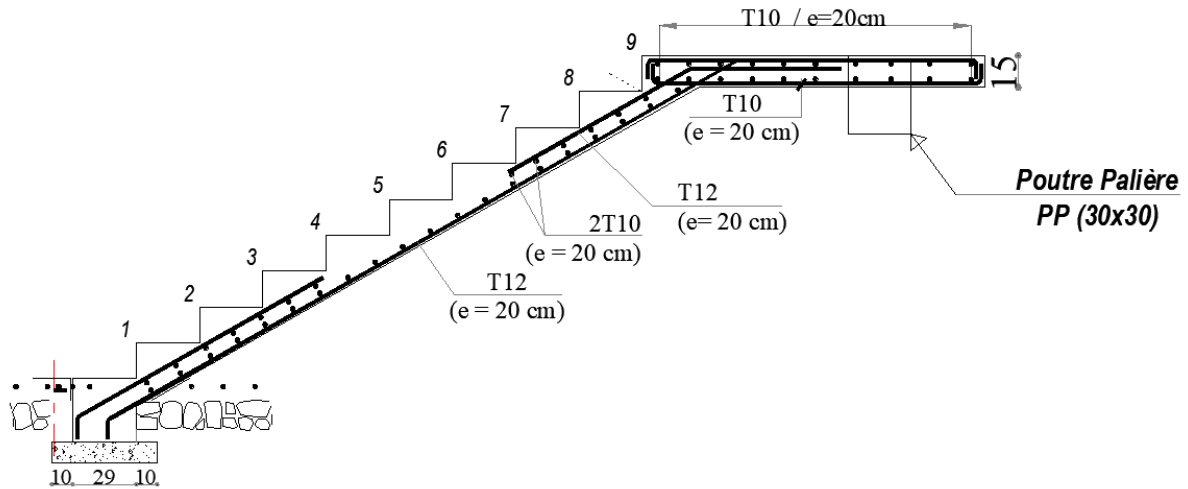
Ferrailage du volée 1 et 2 de l'escalier
